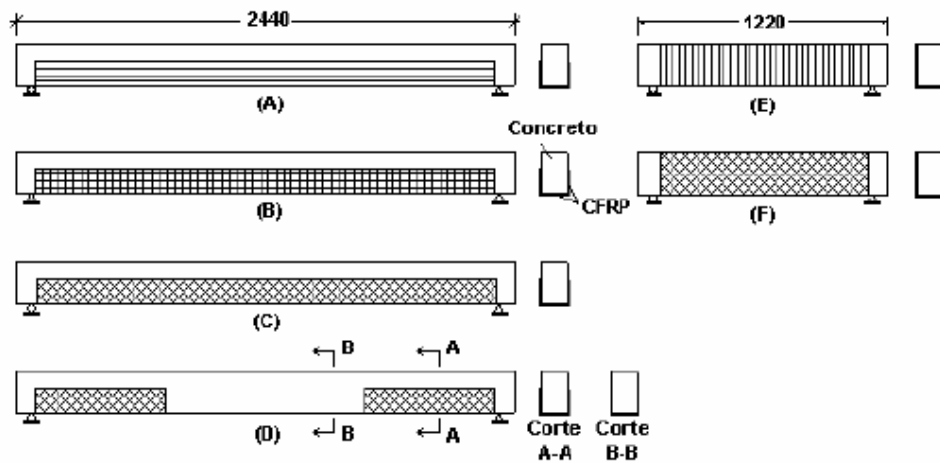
Configuração das vigas reforçadas ao cisalhamento (NORRIS *et al.*, 1997).
